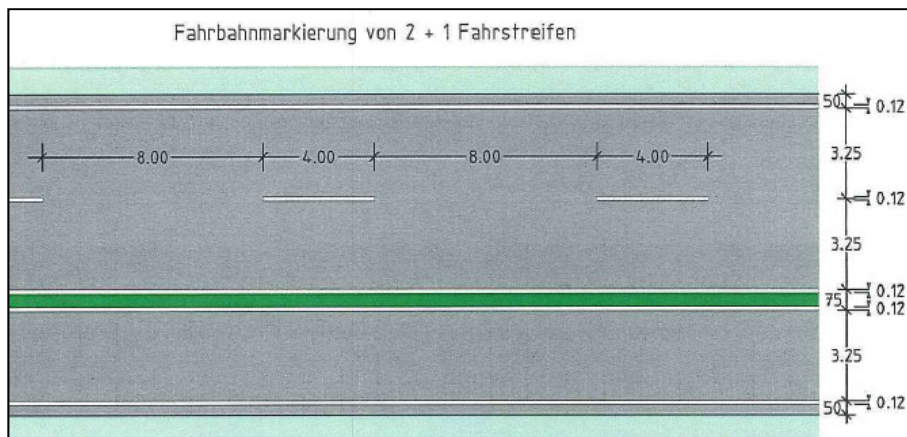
Markierung der freien Strecke (LASuV Bautzen)
